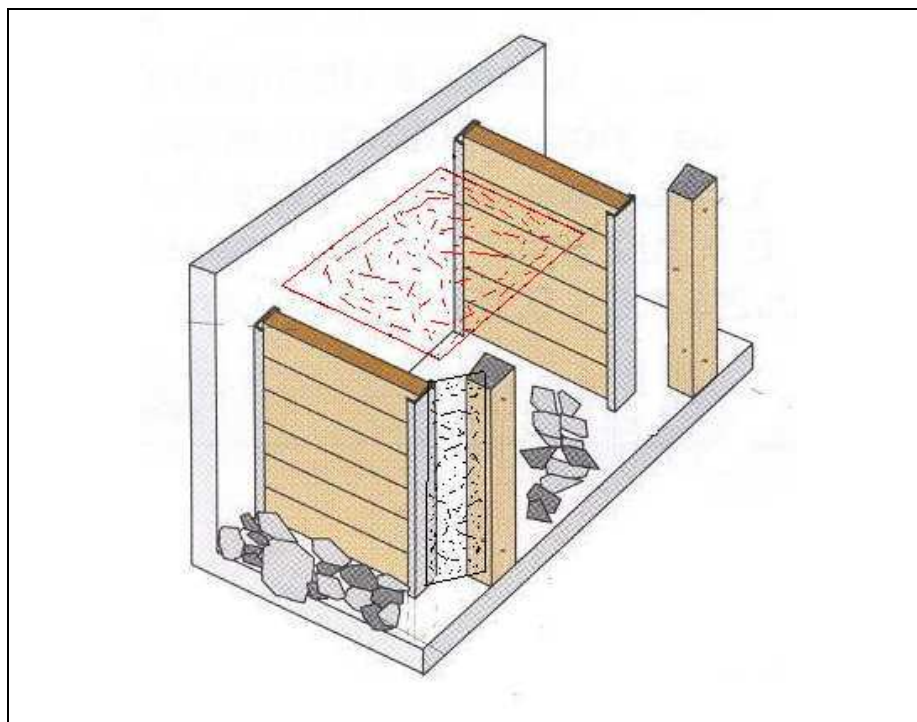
Plano transversal (preto) e plano longitudinal (vermelho)
